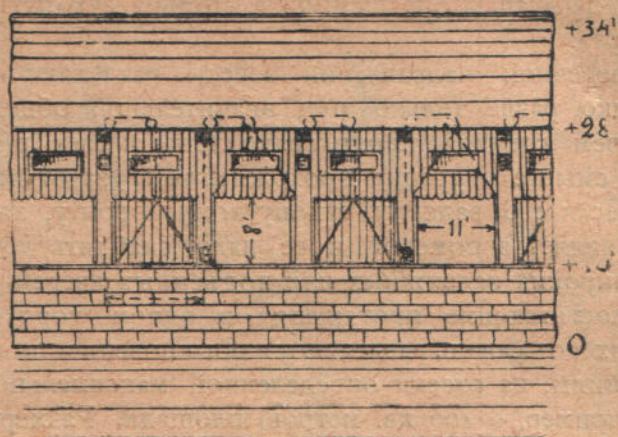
Фасад и поперечный разрез деревянного навеса.
